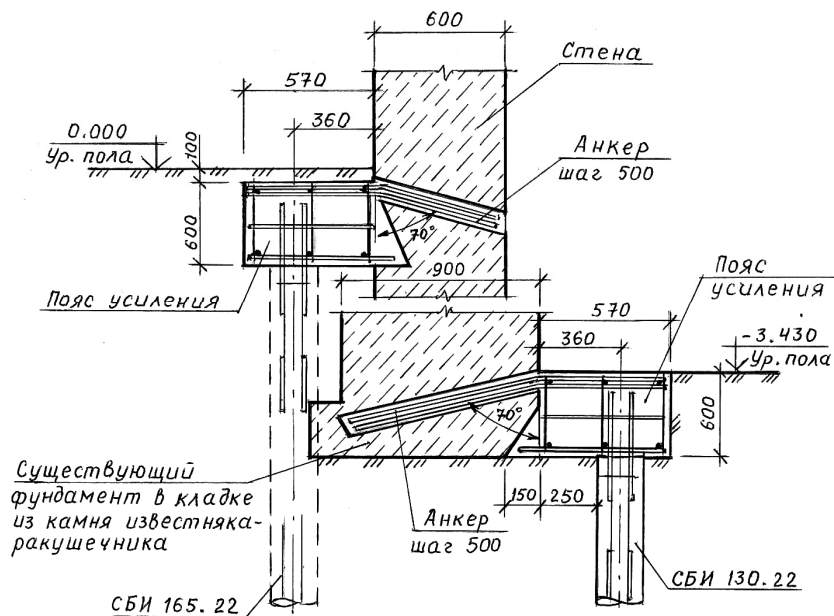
Схема усиления фундаментов здания Гимназии № 1 в г. Одессе
